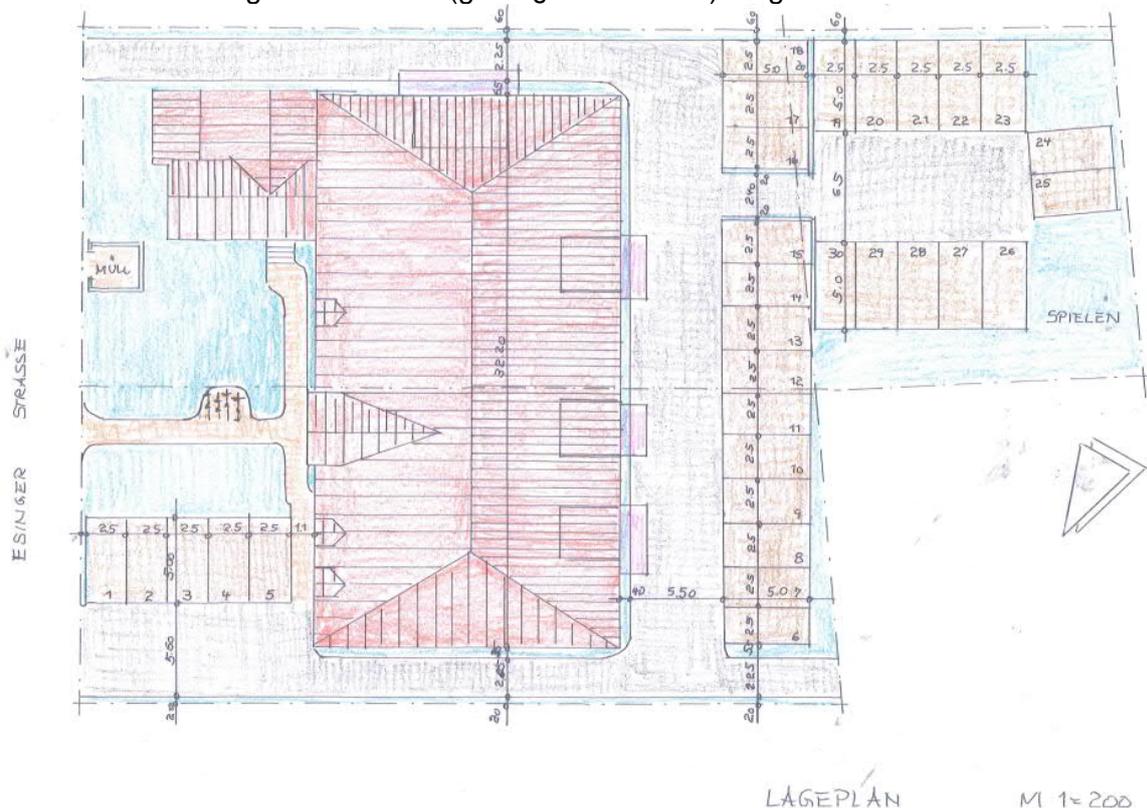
vorläufige Planung für das Mischgebiet - Lageplan [4]
